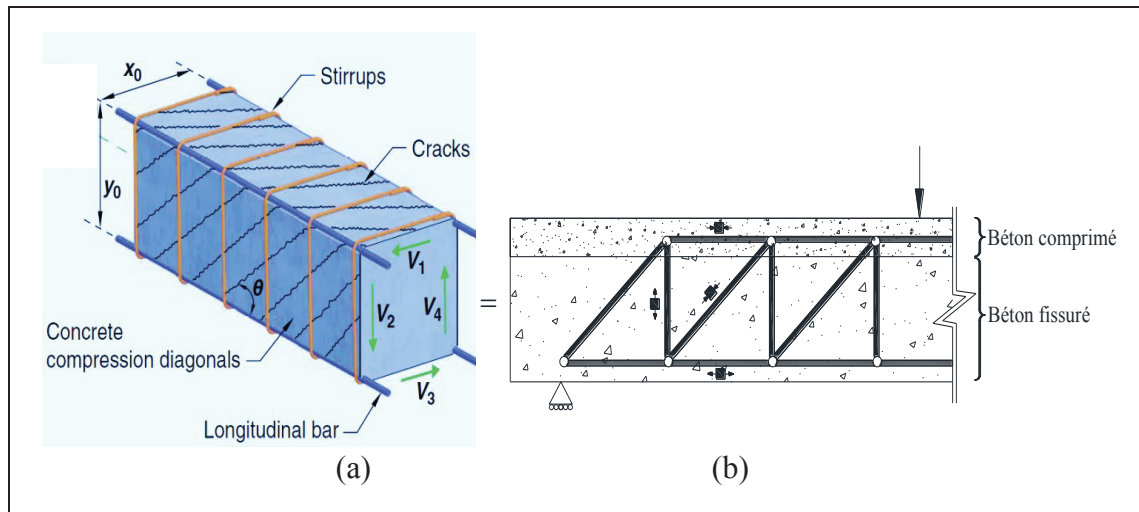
Analogie du treillis a) poutre en BA fissurée
